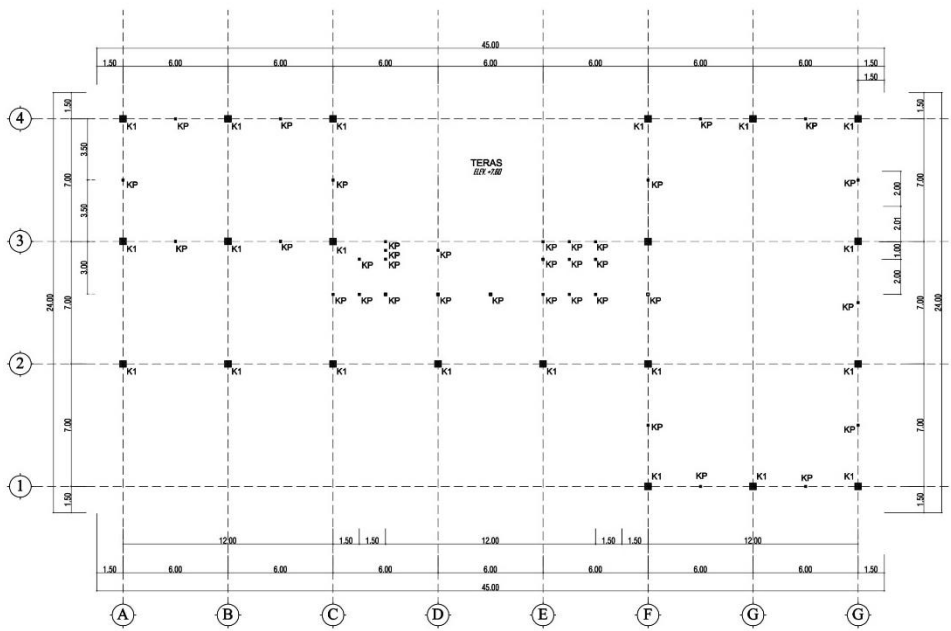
Denah Rencana Kolom Lantai 1.
